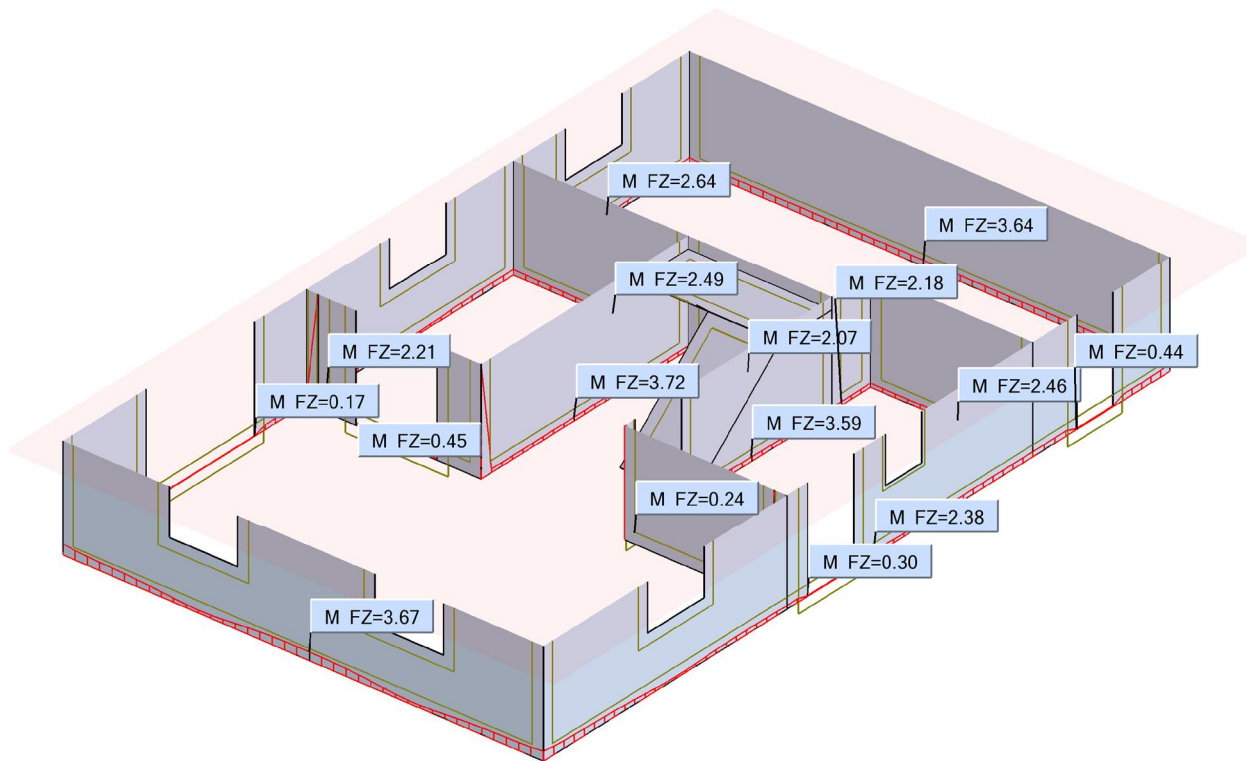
Расчетная линейная нагрузка на ленту фундамента по СОМ 1, т/м
